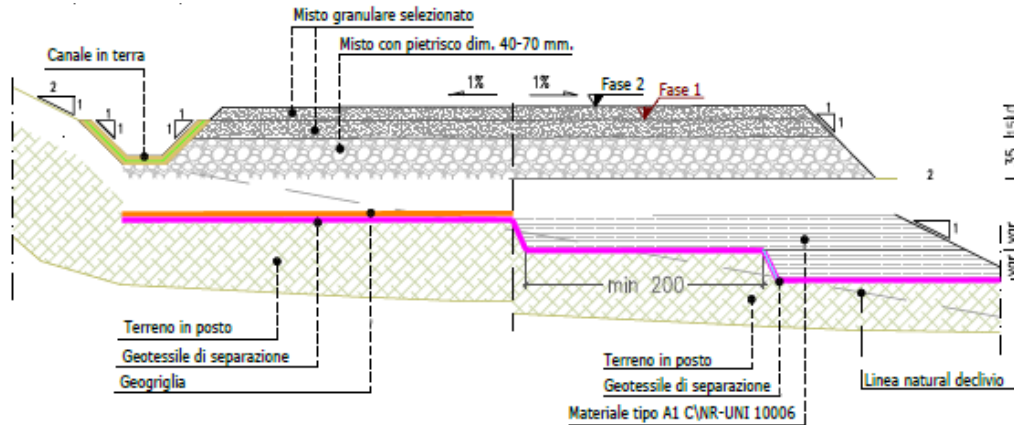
Sezione stradale tratti a mezza costa ($p < 13\%$)
